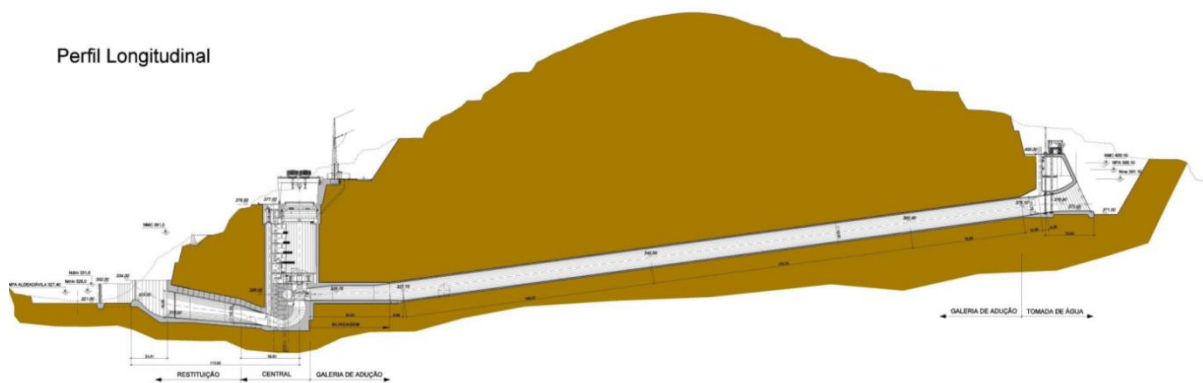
Perfil longitudinal de reforço de Bemposta II (fonte: EDP)
